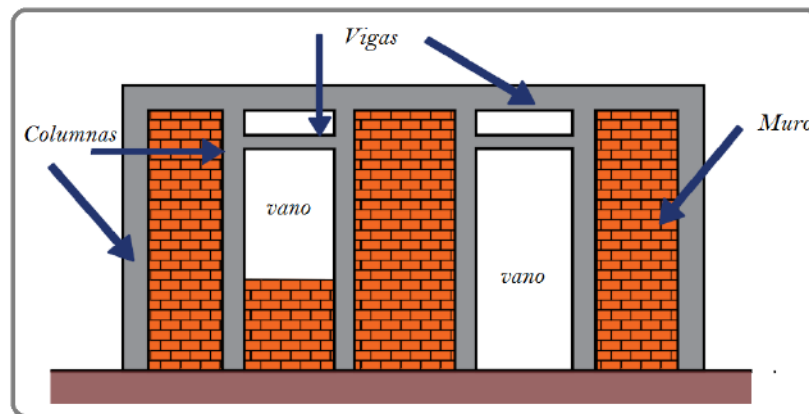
Adecuado reforzamiento de vanos con vigas y columnas.
